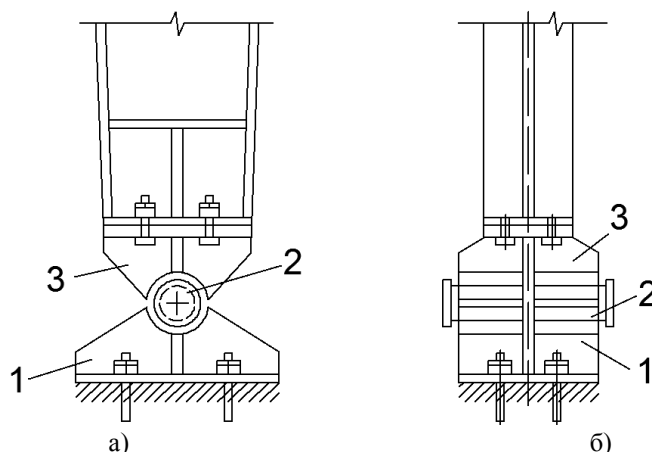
Конструктивная схема балансирного шарнира вид спереди а) и сбоку б):
